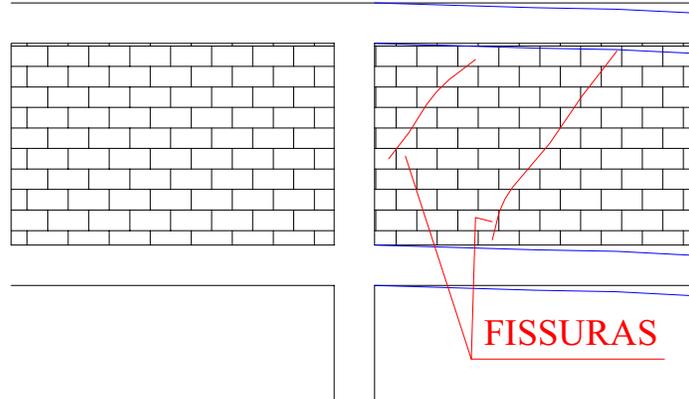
Fissura em alvenaria sobre balanço
